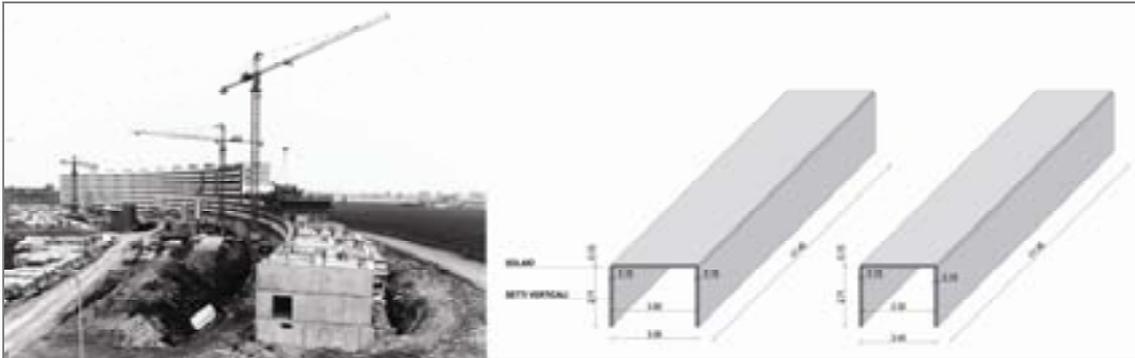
Fasi di realizzazione del getto dei Tunnel corrispondenti ai primi 20 corpi scala realizzati su incarico IACP. Sullo sfondo si notano i moduli in costruzione secondo lo schema strutturale indicato. Archivio fotografico Acer Bologna.
